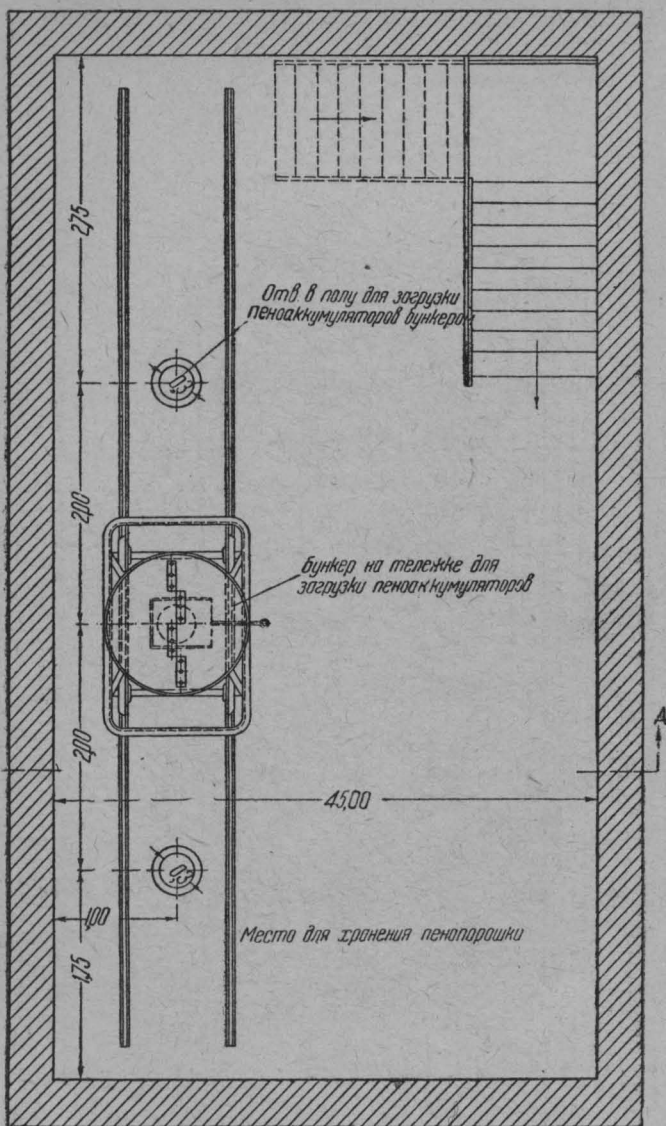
План 2-го этажа здания пеноаккумуляторной станции.
